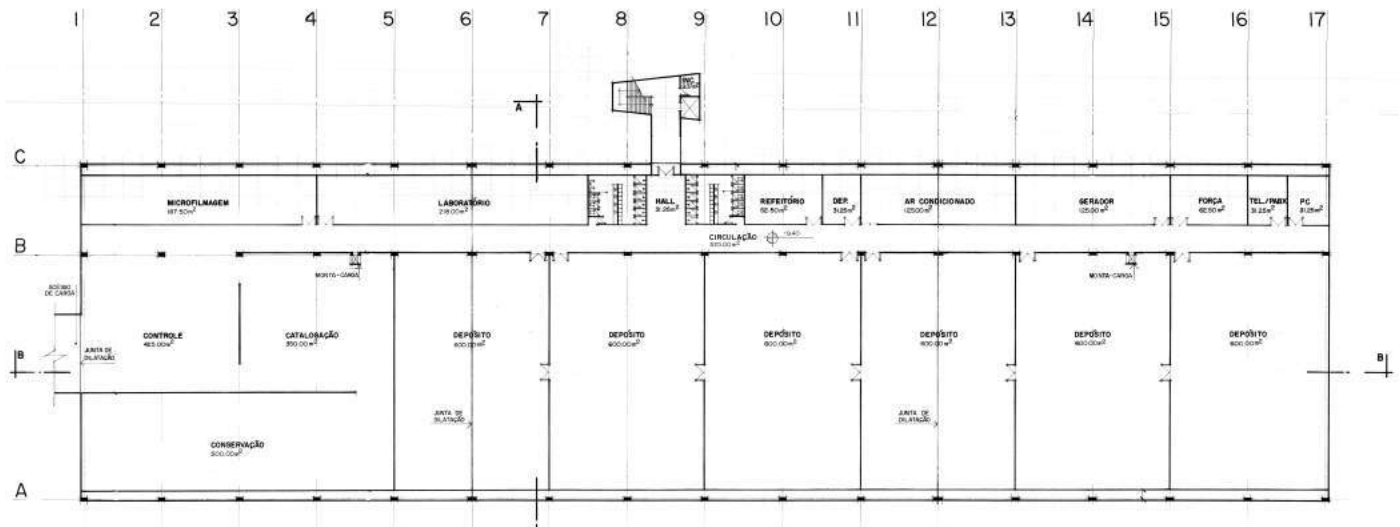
Planta do 1º. subsolo da Biblioteca Nacional, 1992. Fonte: ArqPDF.
